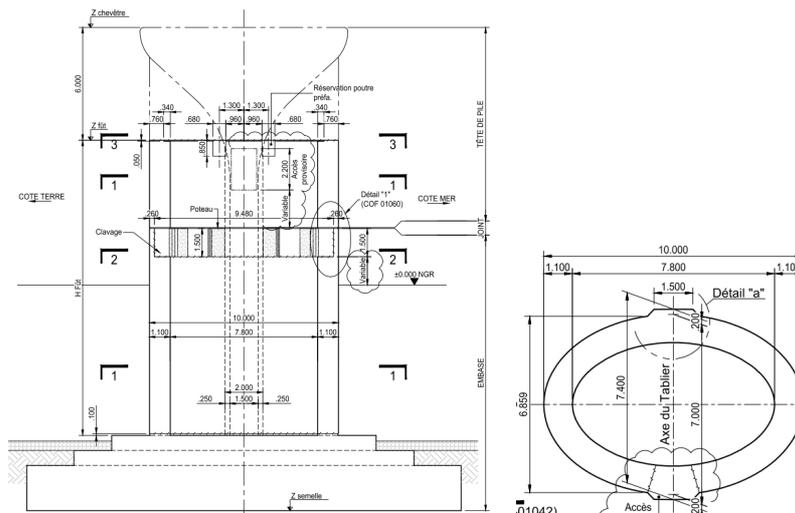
coffrage transversal des piles et des fondations et coupe 1-1 en section courante
